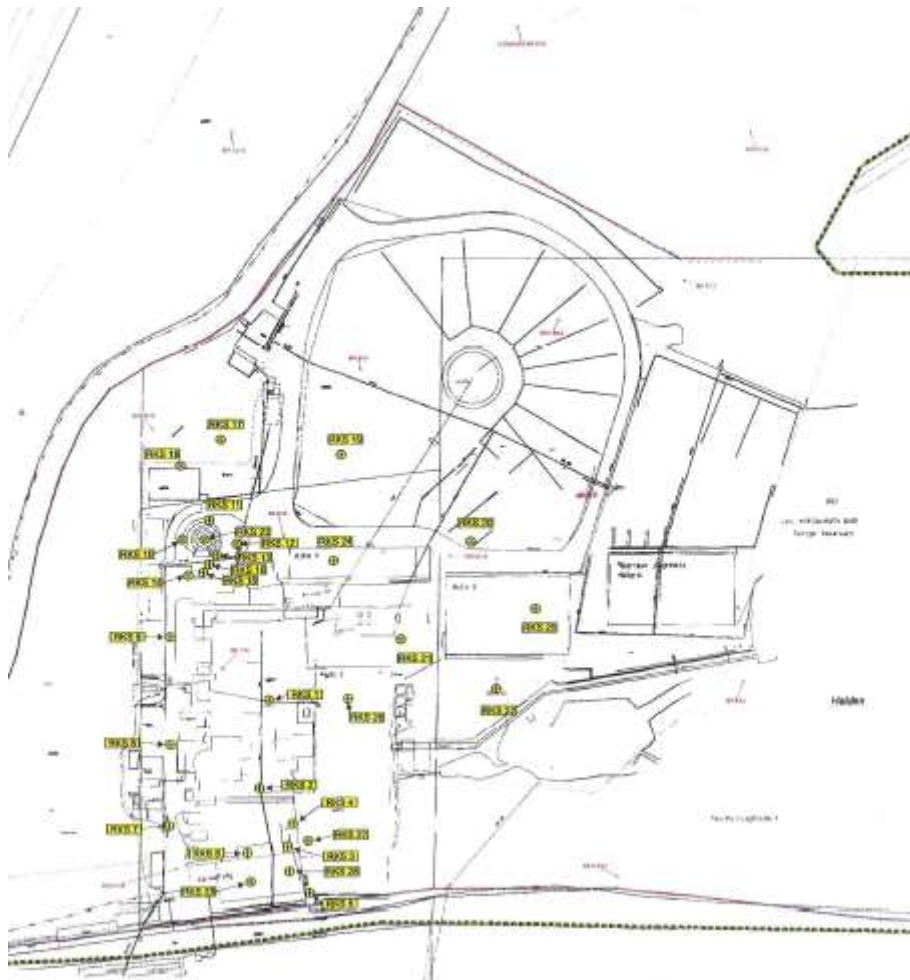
Lage der Bohraufschlüsse zur Boden- und Untergrunduntersuchung
